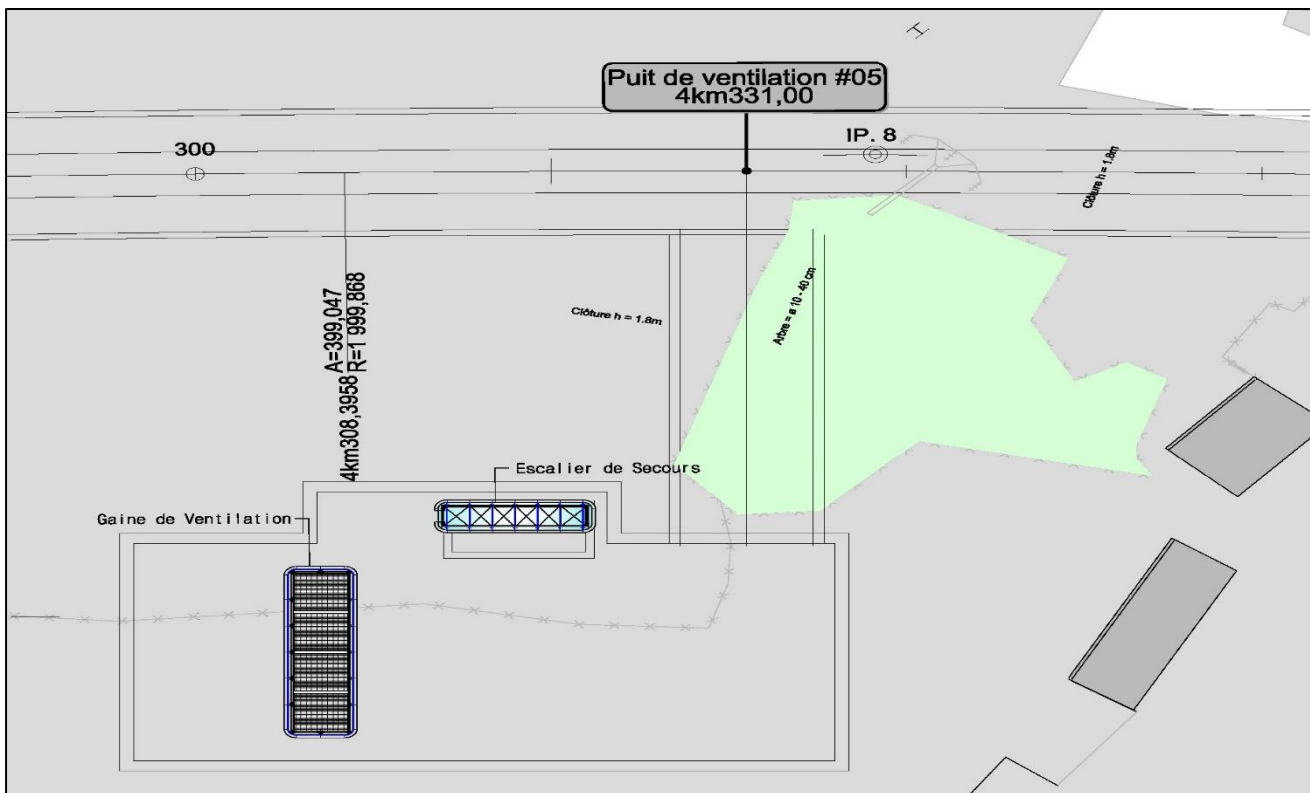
vue en plan du niveau dalle de couverture R0 [1]
